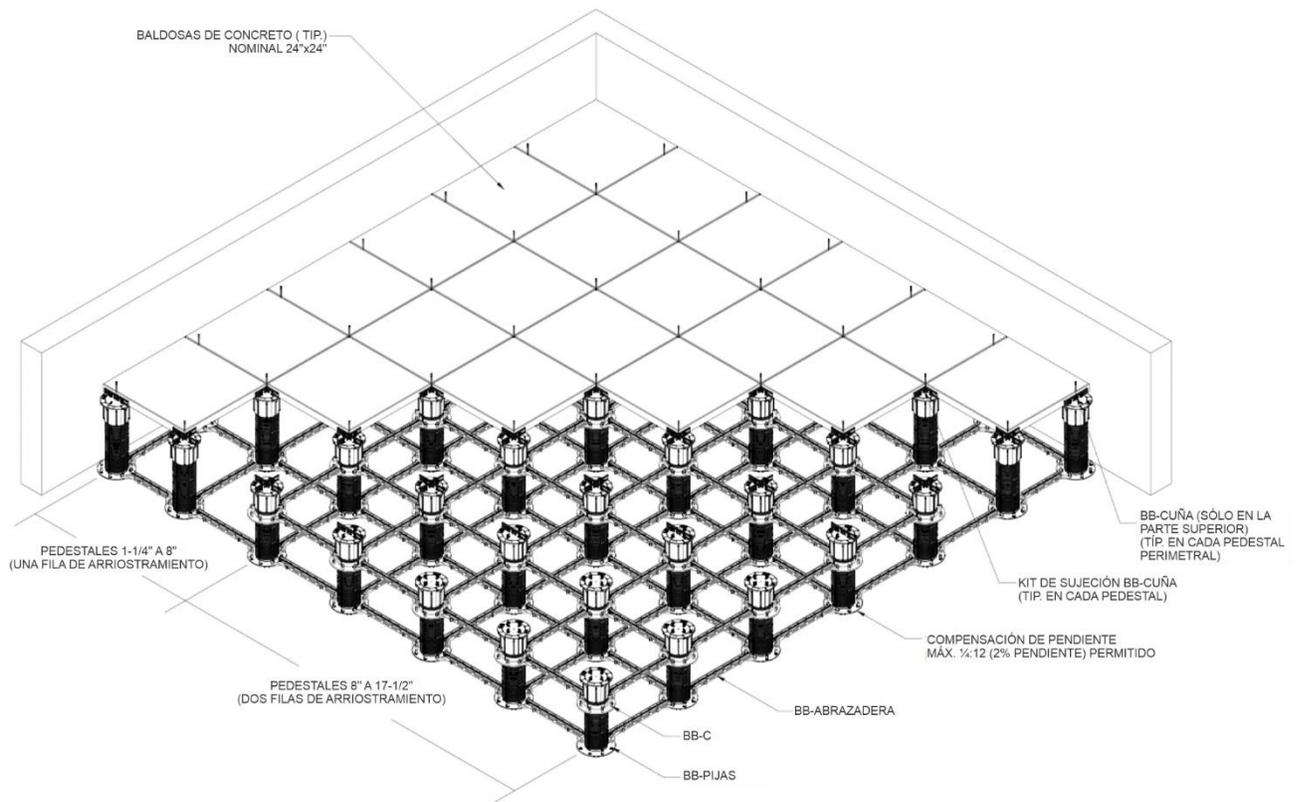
SISTEMA SÍSMICO DE BALDOSAS DE CONCRETO
